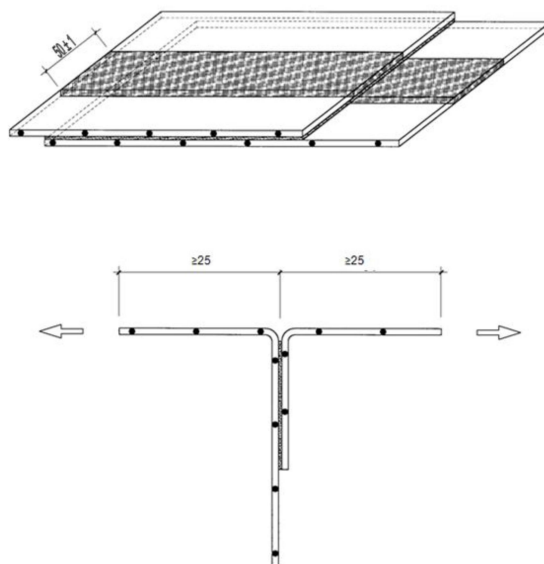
Probeta para ensayar la soldadura por pelado (AENOR 2015)
